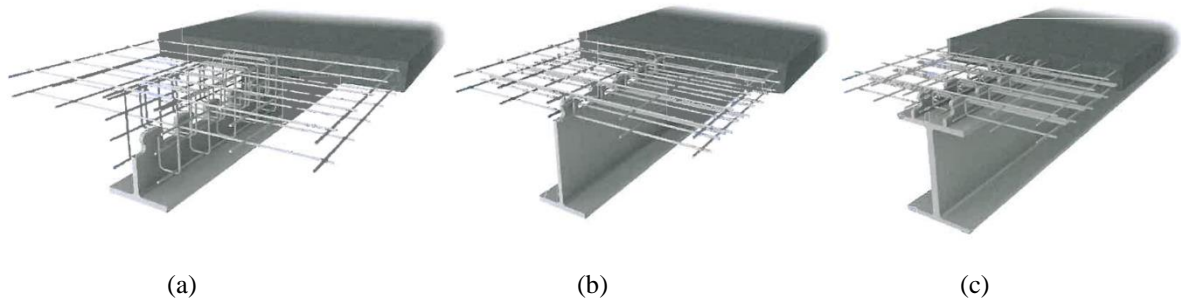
Configurações de projeto para o uso de conectores *composite dowels* (Z-26.4-56, 2013): (a) alma do perfil T engastada; (b) região do conector engastada; (c) conectores soldados e laje sobre a mesa do perfil I.
